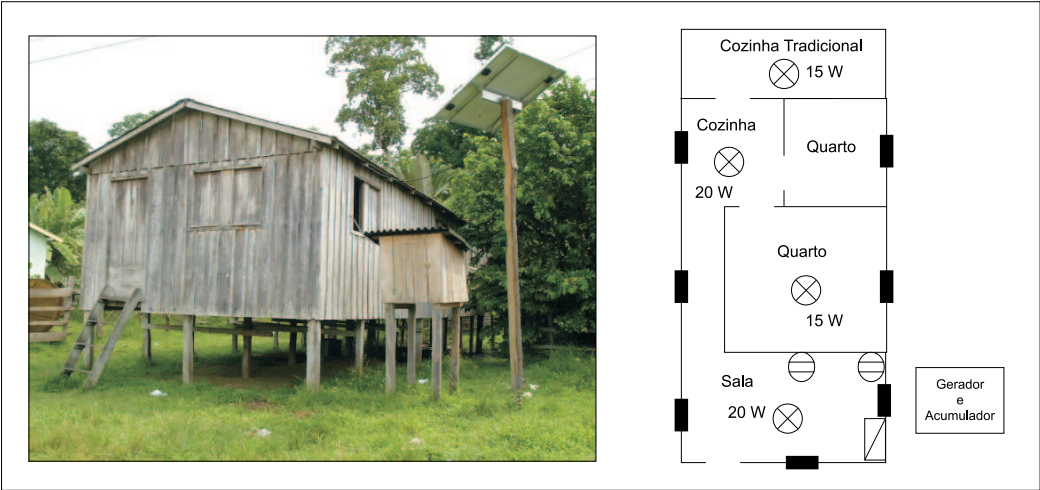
Vista externa do SFD9 e planta aproximada do domicílio.
